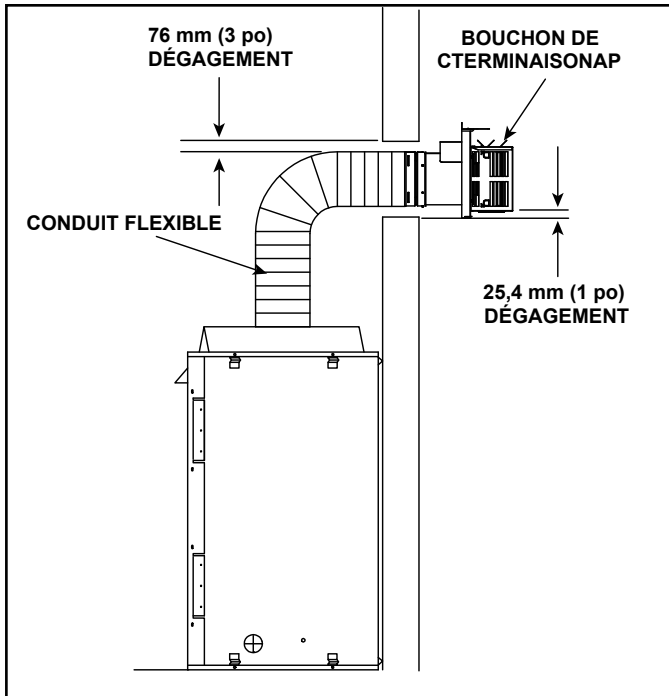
Conduit d'évacuation flexible – Foyer générique illustré
